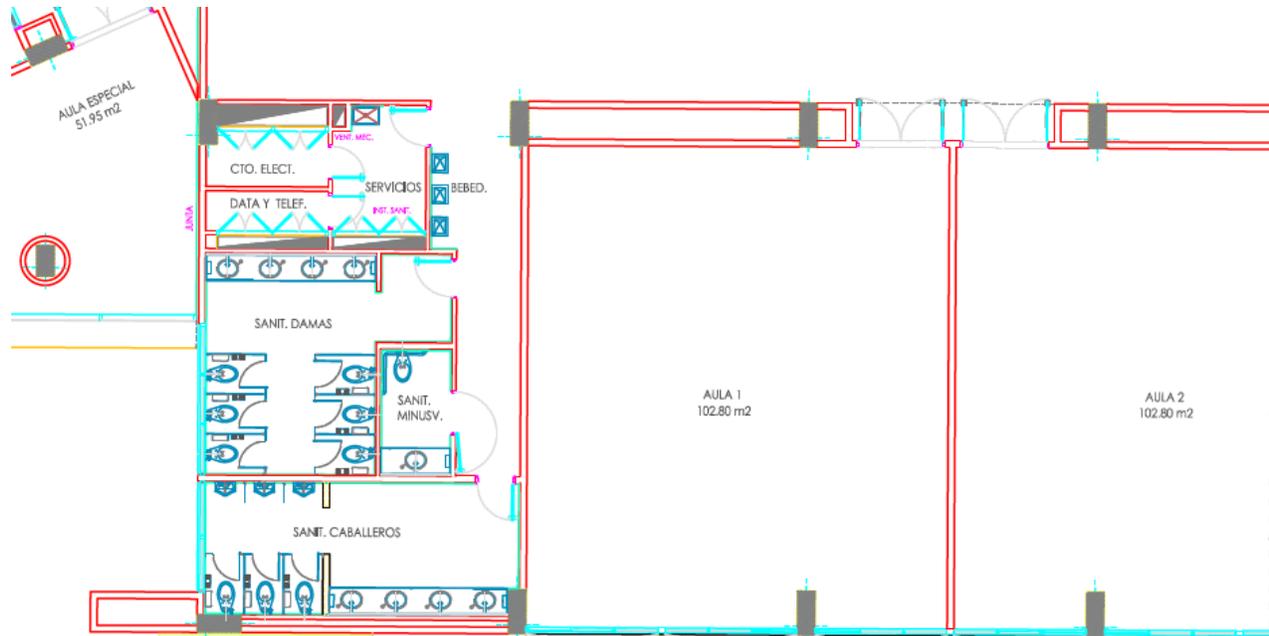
Planta Piso 2 del Nuevo Edificio Ingeniería
